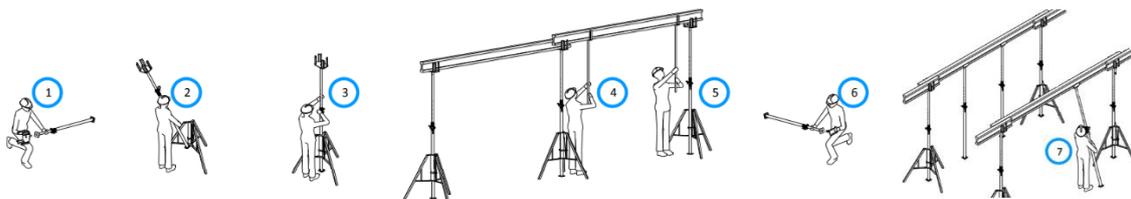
Montaje de sistema de apuntalamiento con vigas H20 y puntales paso a paso.
